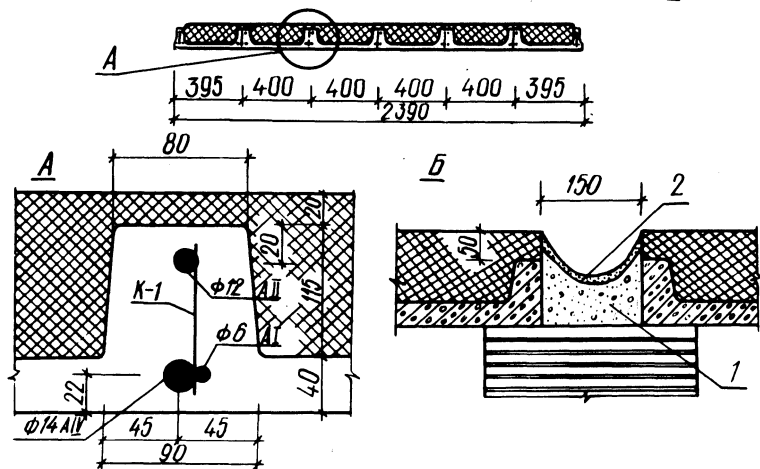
Панель неветилируемого покрытия: А - продольное ребро; Б - опирание панелей на внутреннюю продольную стену; 1 - керамзитобетон; 2 - цементный раствор.
